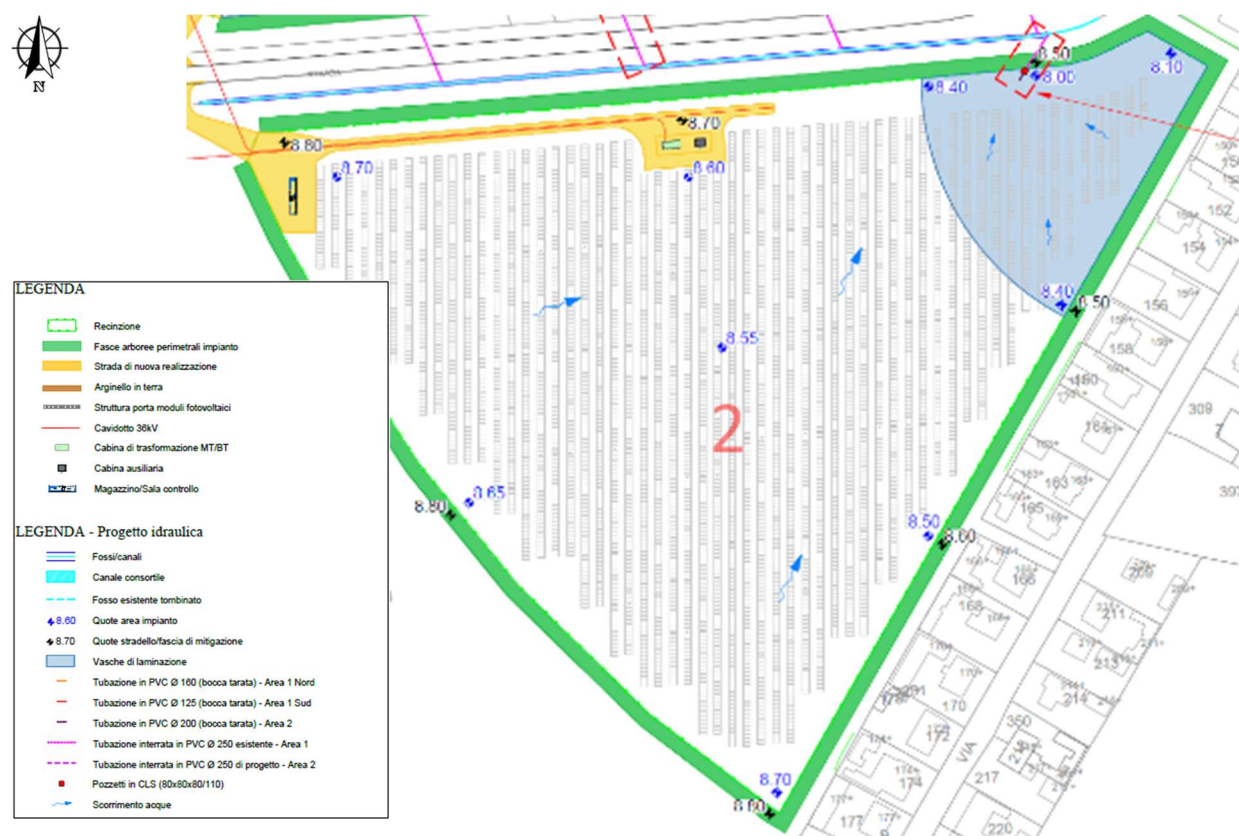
Planimetria area 2 con individuazione scarichi e vasche di laminazione (stralcio Tav. 43A)
